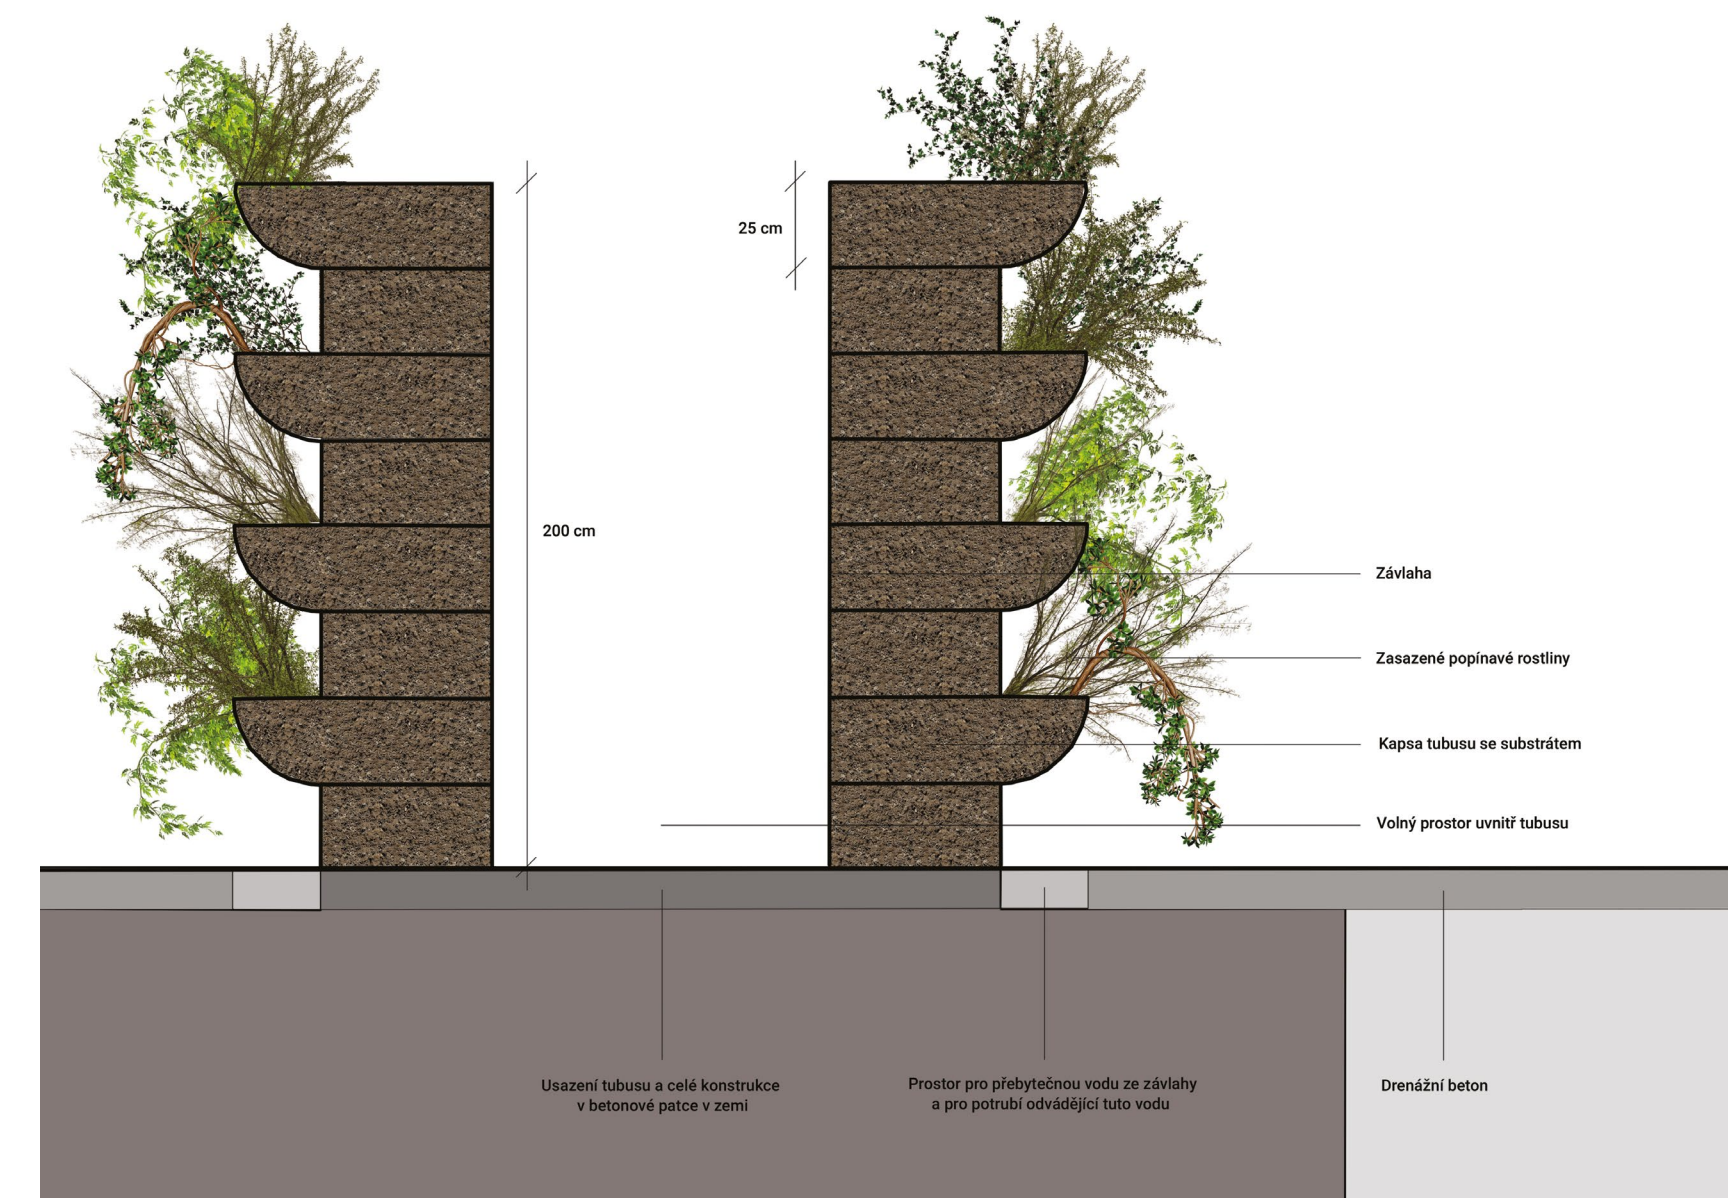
Technický prvek - Vodovodný řez tubusem, zdroj: autor práce
